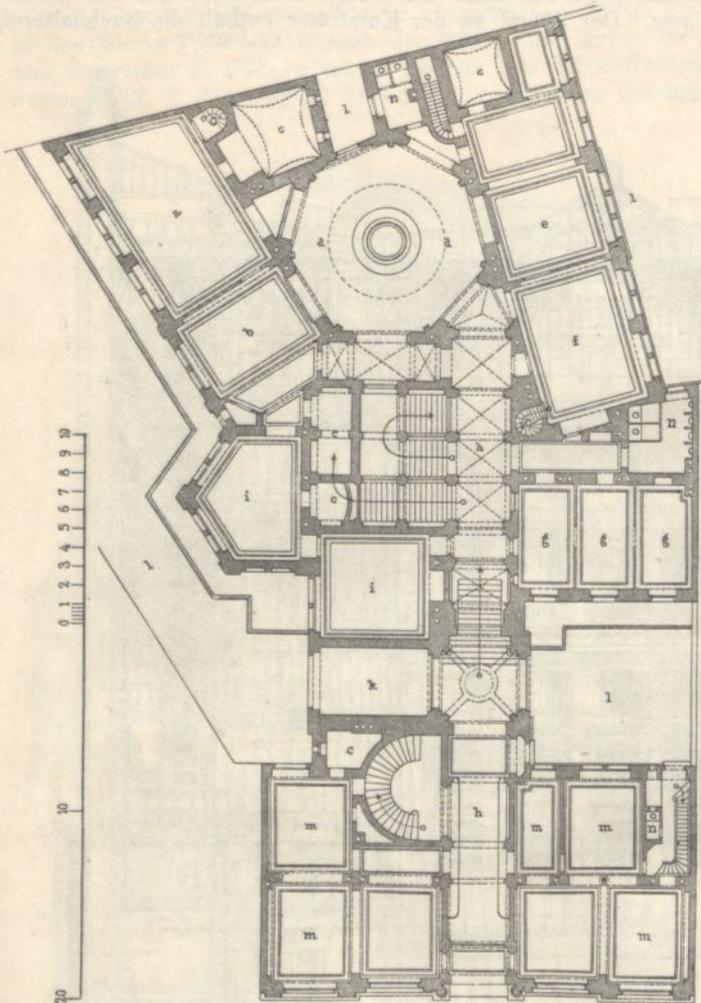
Bankgebäude in Frankfurt. Erdgeschoss
